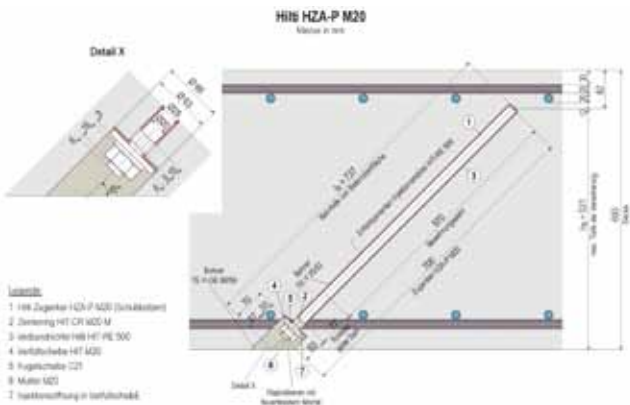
Детальная схема установки армирующего стержня Hilti HZA-P
